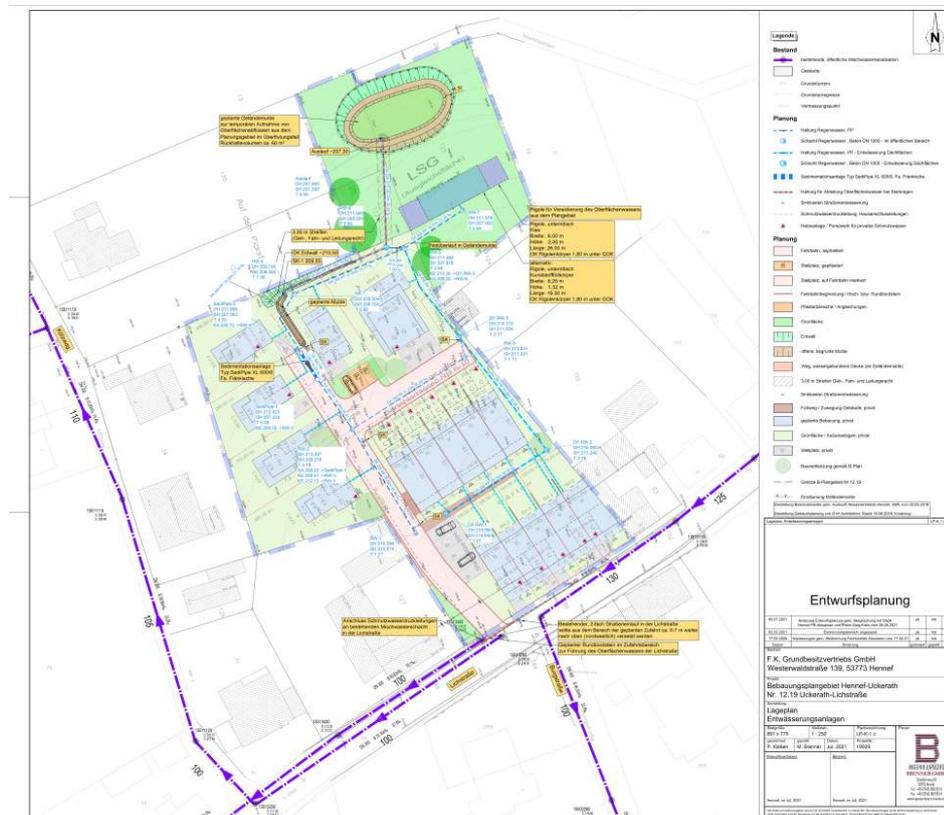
Fachplanung zur Entwässerung, Lageplan (Quelle: Ingenieurbüro Brenner GmbH)
